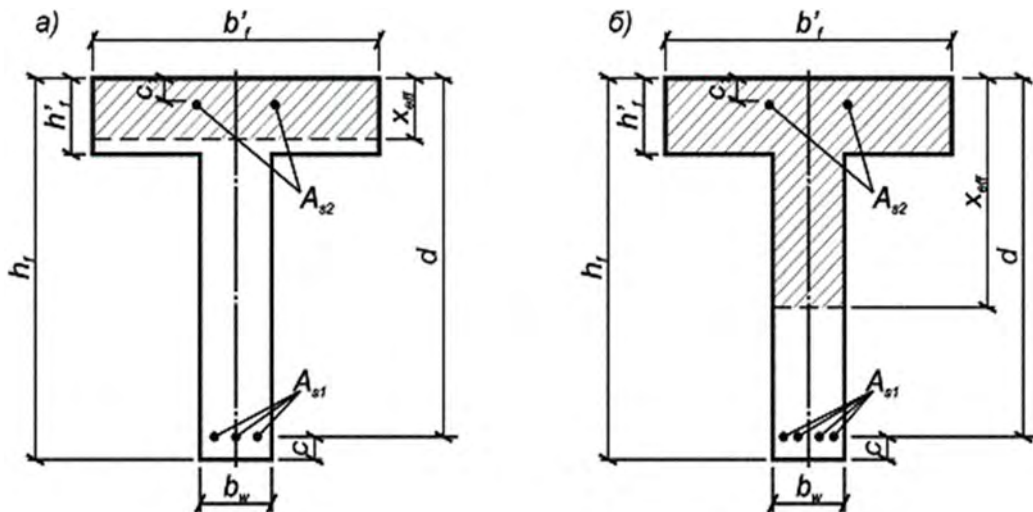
Положение границы условной сжатой зоны в сечении изгибаемого железобетонного элемента тавровой формы
